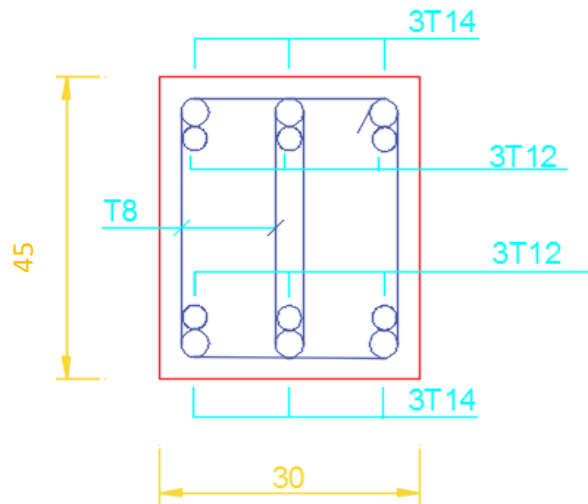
Ferrailage des poutres principales (travée et appuis)
